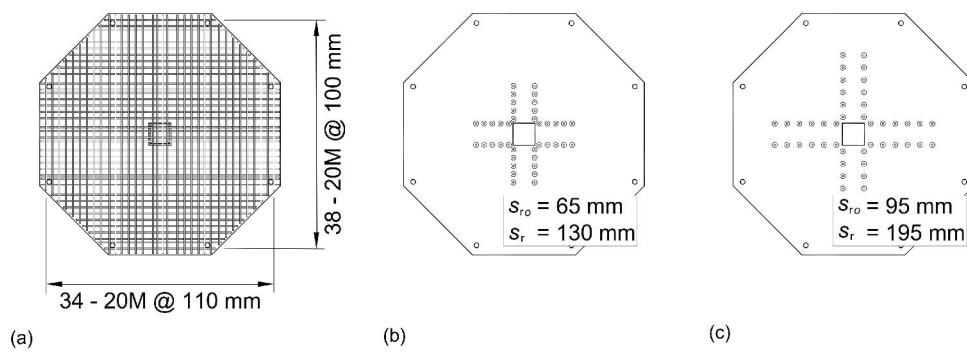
Armadura de flexão e disposição dos "studs": (a) Armadura de flexão das lajes 10 a 12; (b) Disposição dos "studs" na laje 11; (c) Disposição dos "studs" na laje 12 [8].
